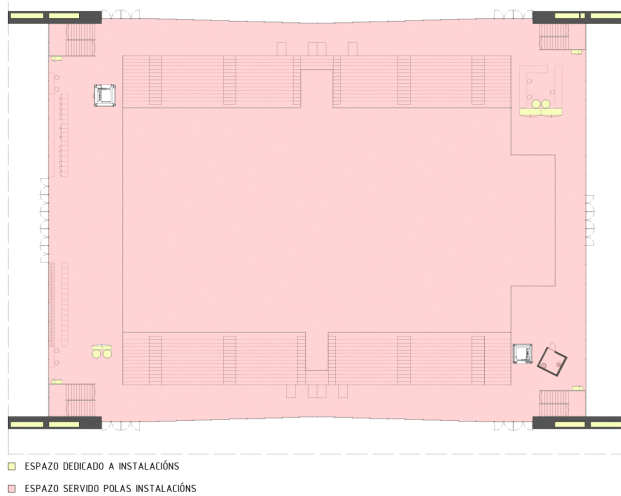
Esquema de ocupación das instalacións na planta de acceso.
